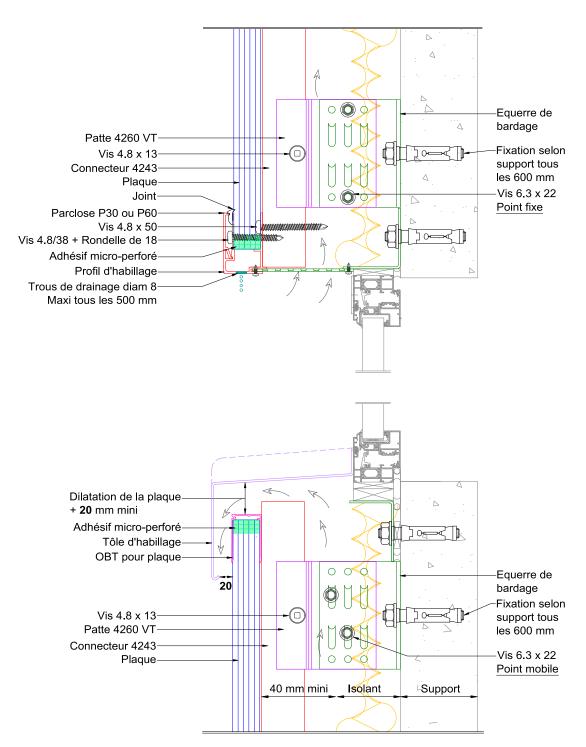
Encadrement d'une baie en tableau - Coupe verticale
